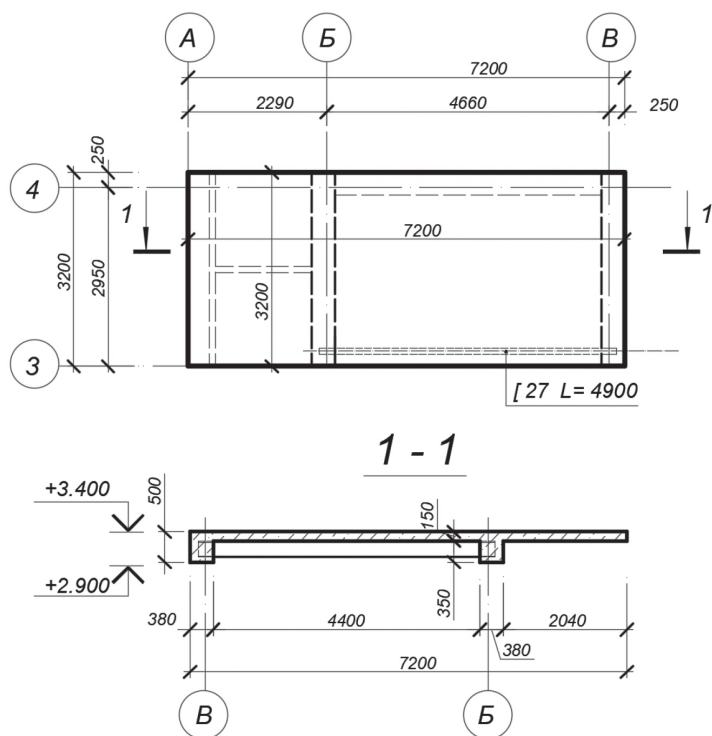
План перекриття на відм. +3.400 та переріз 1-1 плити перекриття
